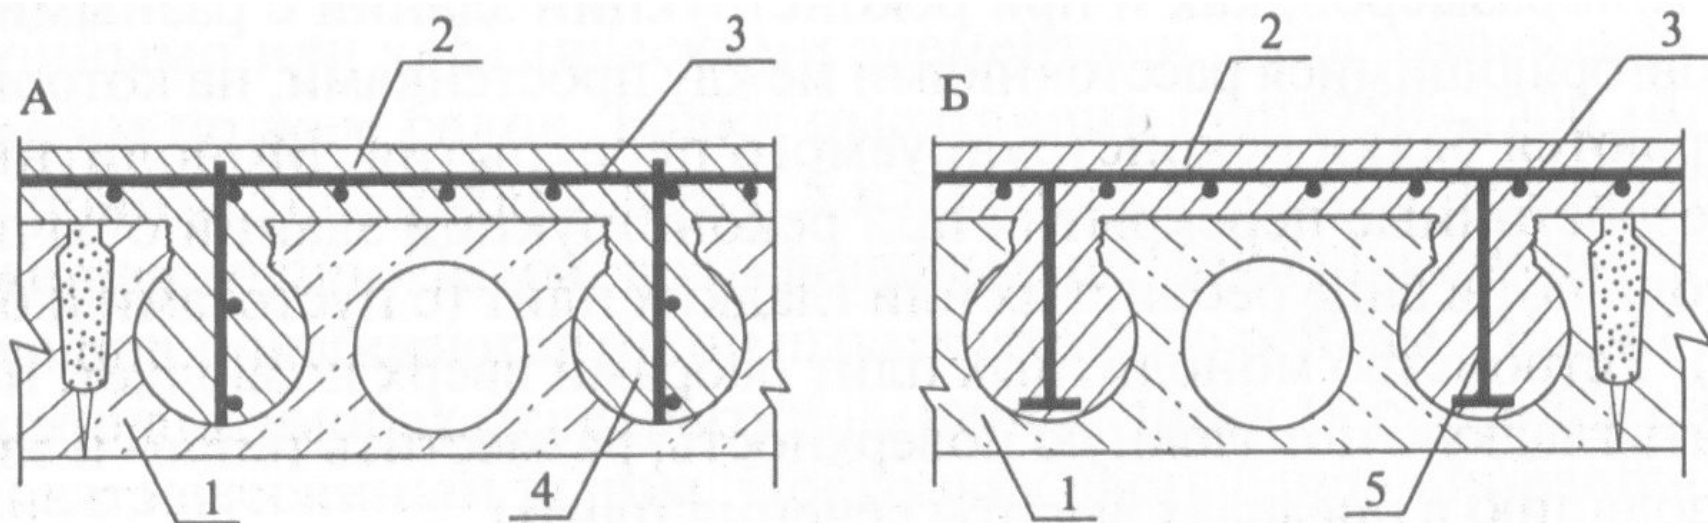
Усиление сборной многопустотной плиты перекрытия:
